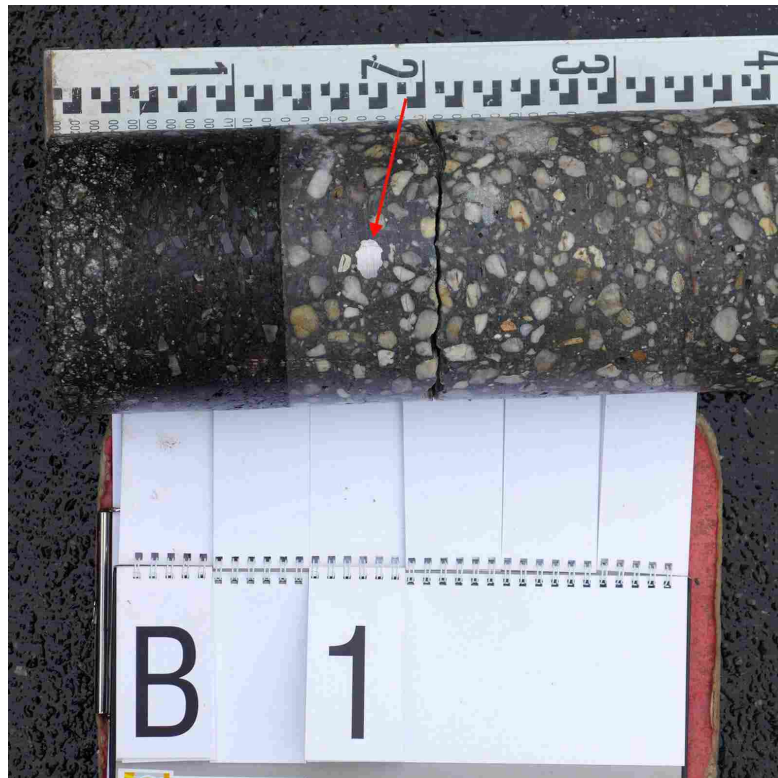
B1 (A) - Asphaltdecke und Beton-Fertigteilplatte mit Detail Bewehrung
